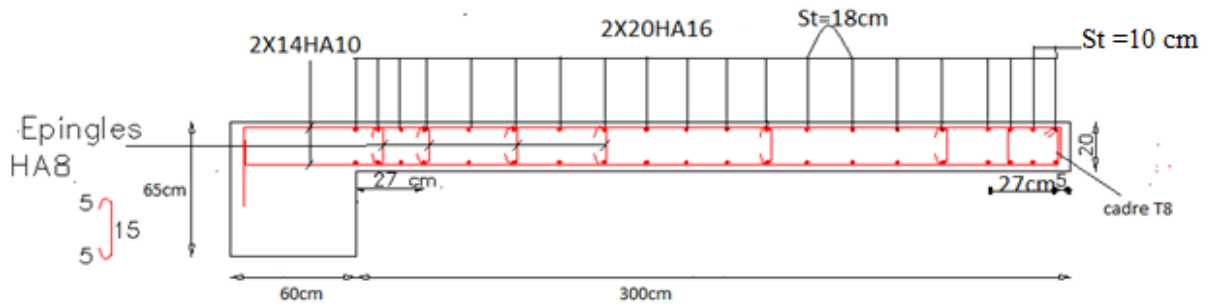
Schéma de ferrailage du voile 1^{er} étage
